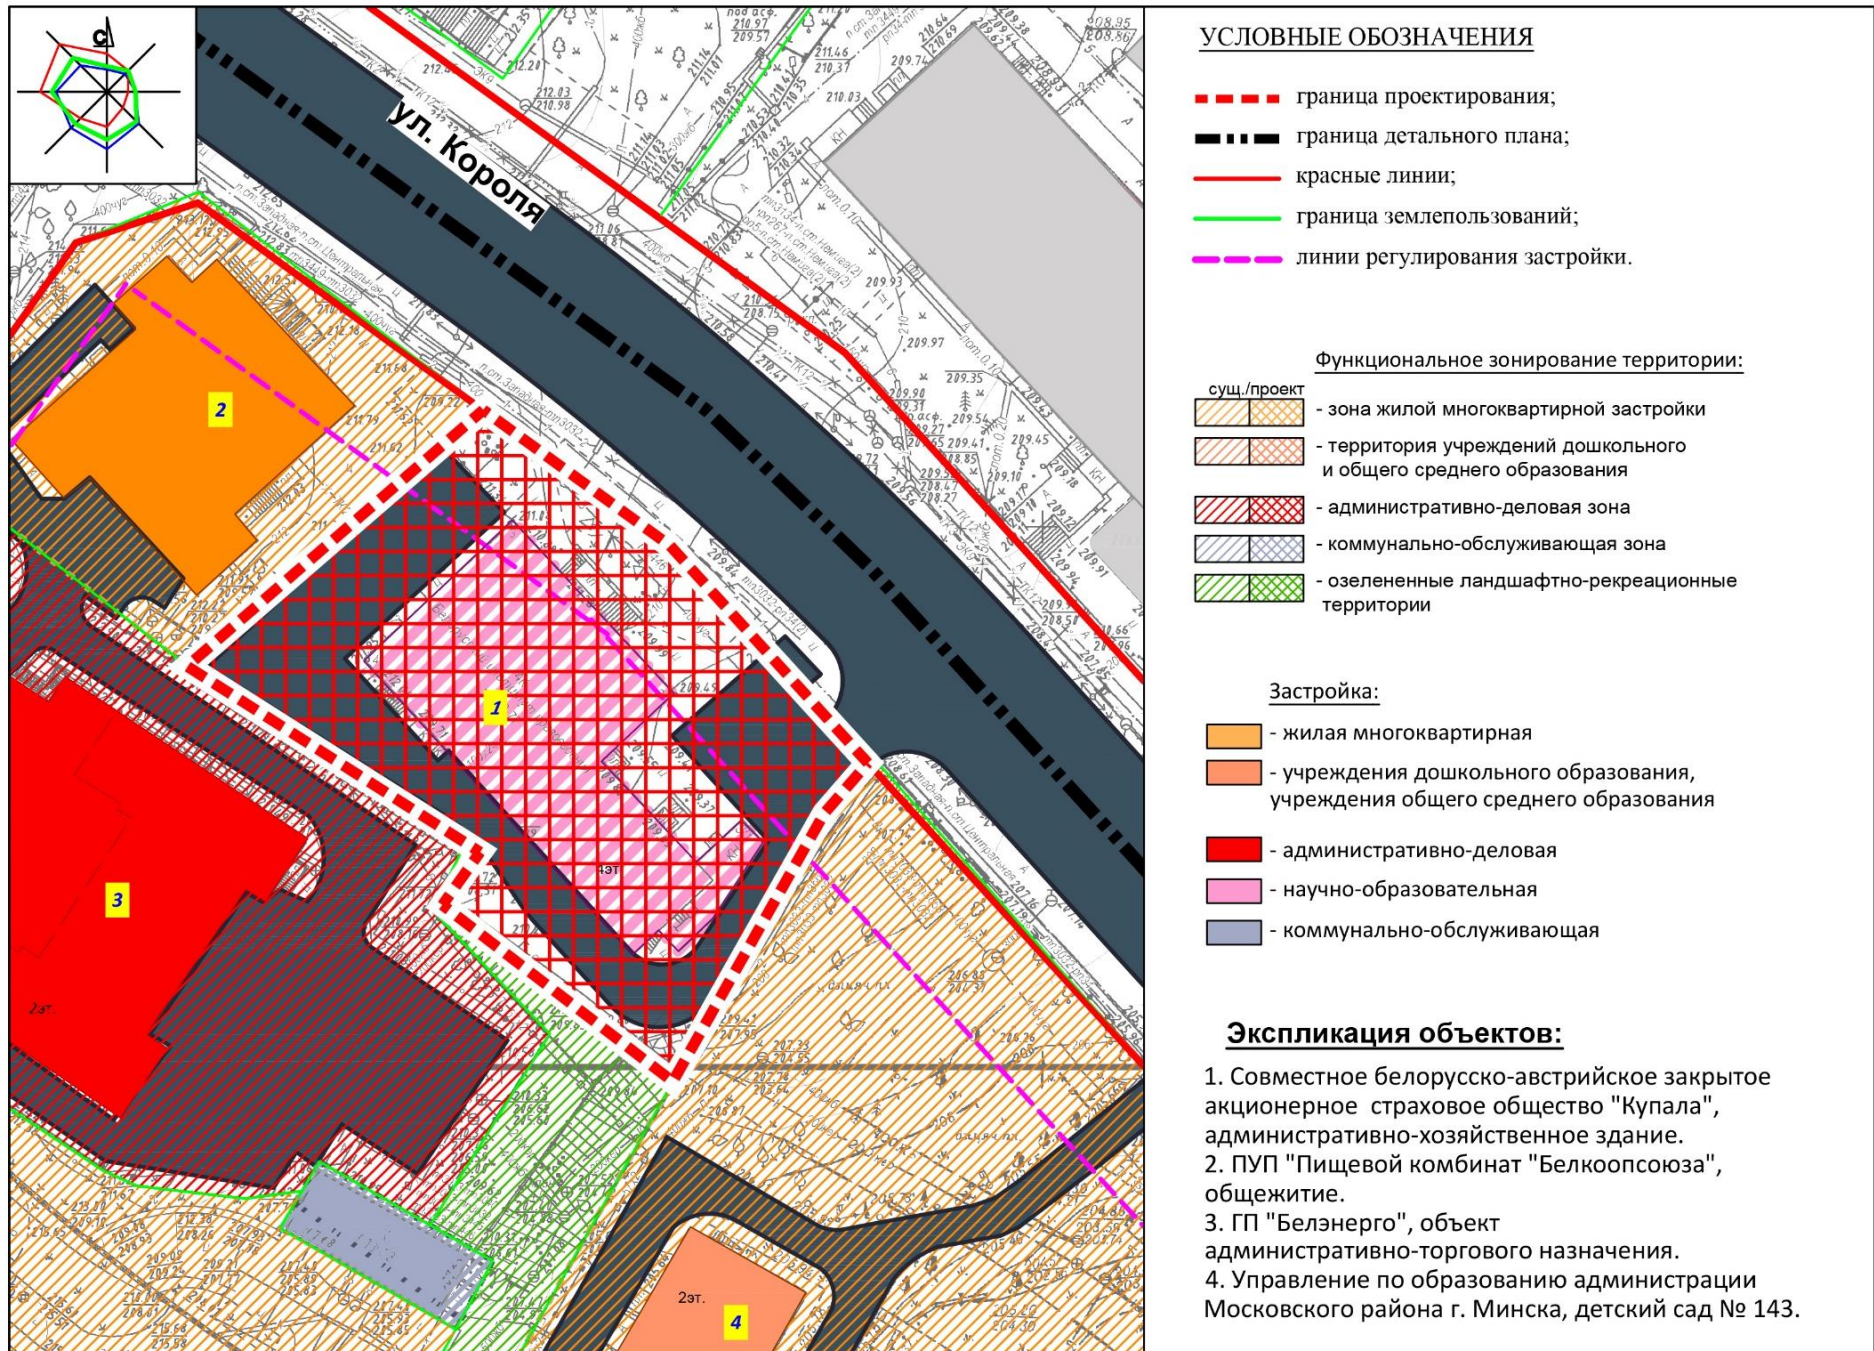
Фрагмент детального плана с учетом отступления
